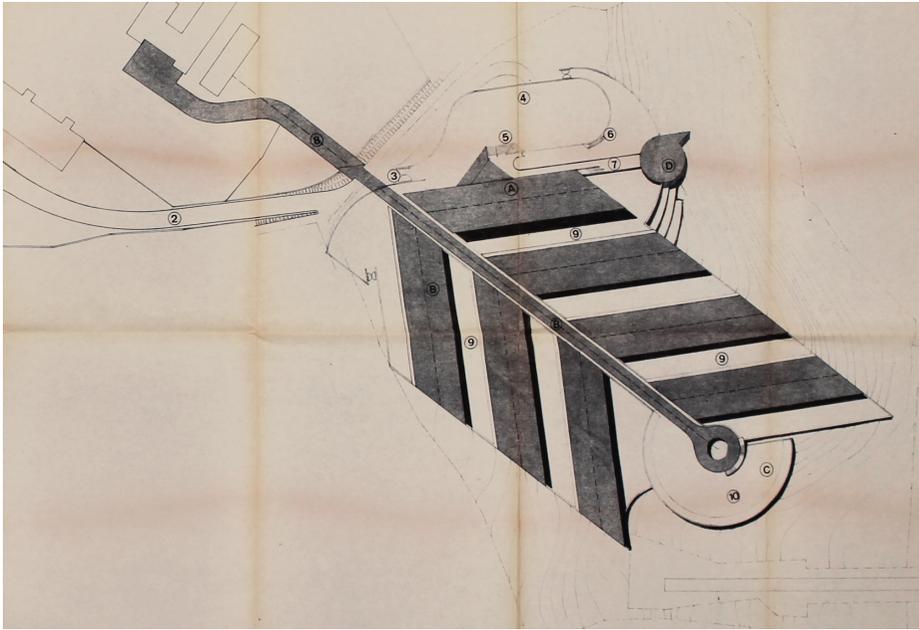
Potenza, Istituto ortofrenico, planimetria di progetto (Archivio Casa della Divina Provvidenza - ACDP a Bisceglie).
